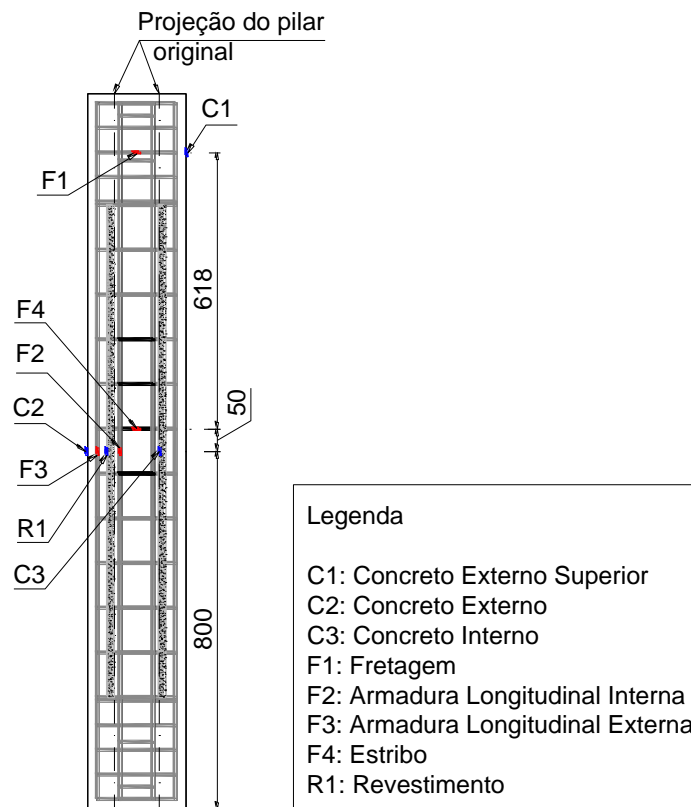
Posicionamento dos extensômetros do pilar PR₁₀₀
